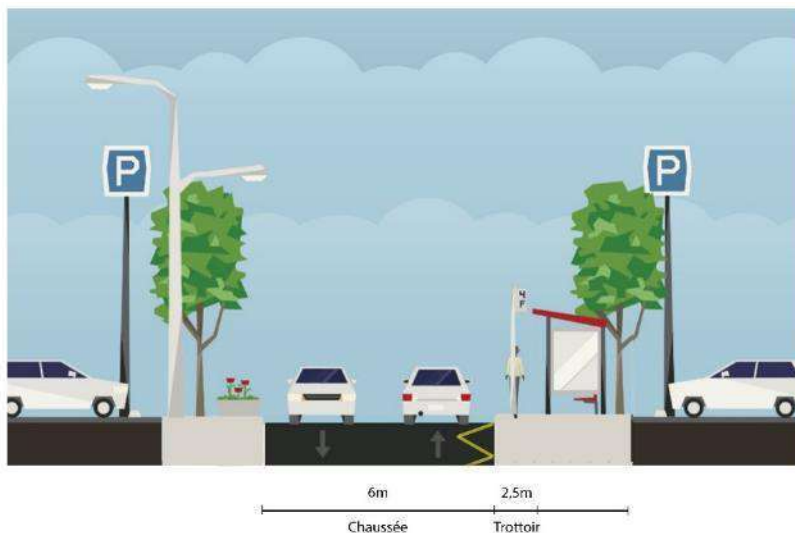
Profil en travers schématique 2 - Place Jaffré
